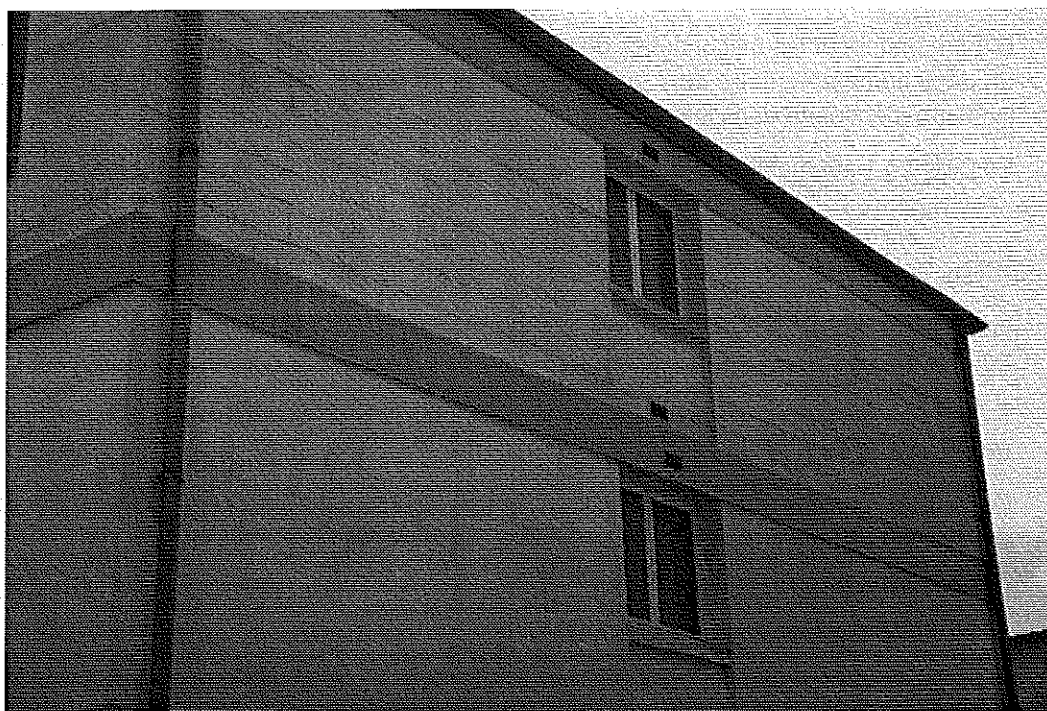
Pignon constitué de blocs béton avec enduit de mortier hydraulique. Fissuration systématique de l'enduit au droit des joints de hourdage. © J. Putatti
